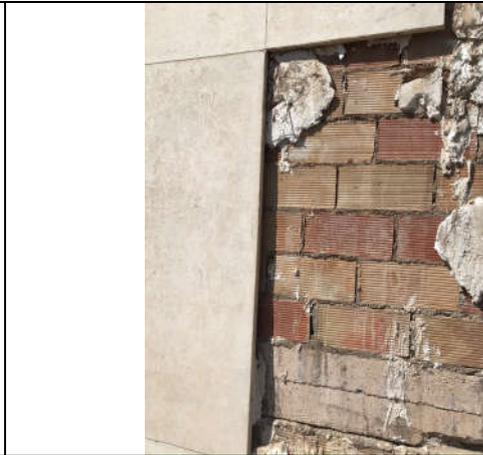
Restos de la corrosión del armado en el canto de forjado adherido a la pieza de aplacado de fachada.
